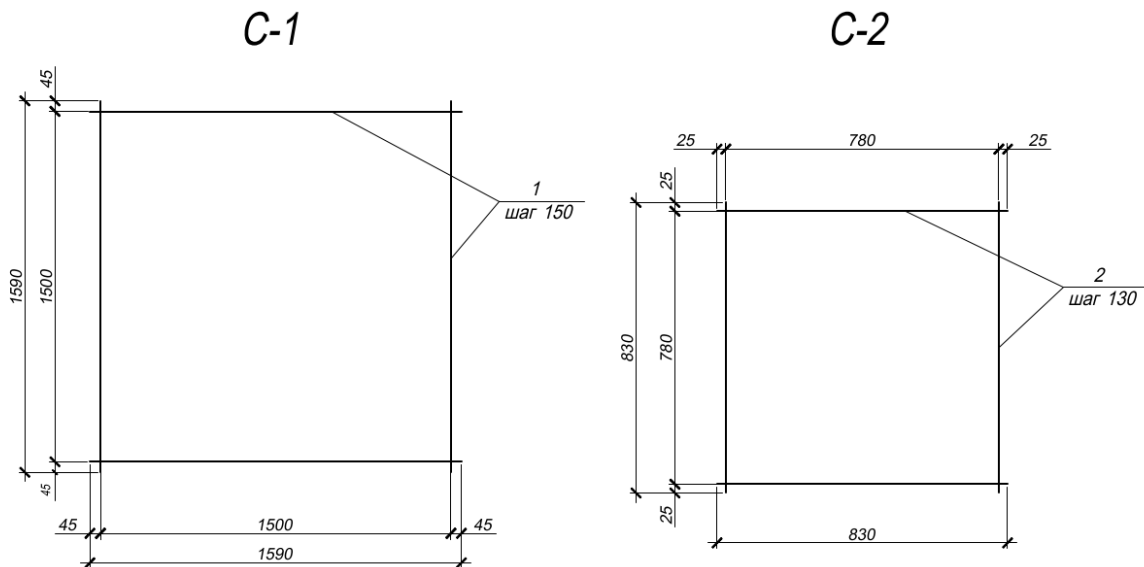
Армування фундаменту (деталі сіток С-1, С-2)
